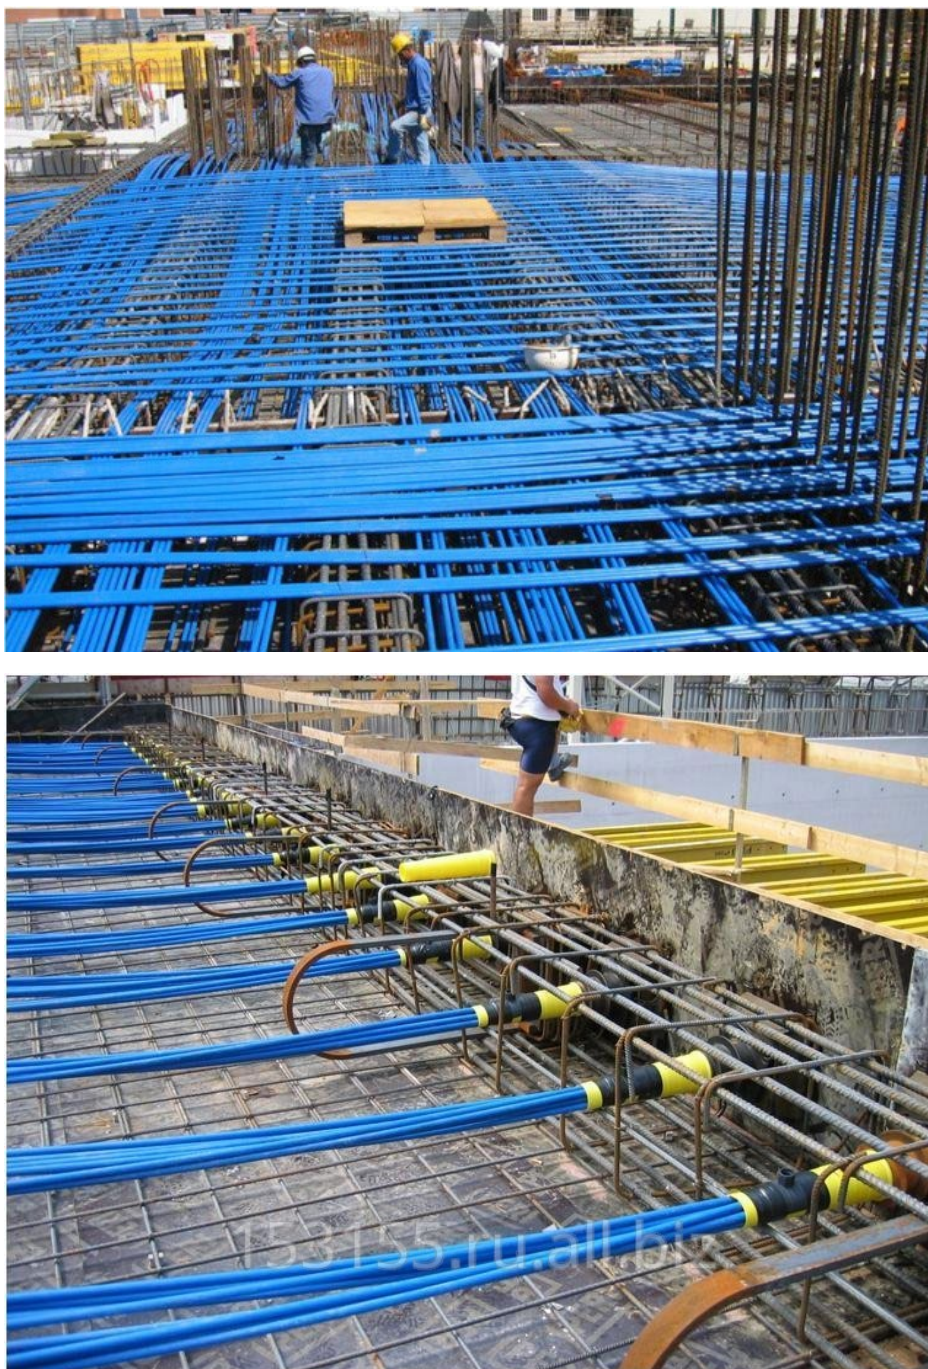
Монолітне перекриття з попереднім напруженням без зчеплення з бетоном
